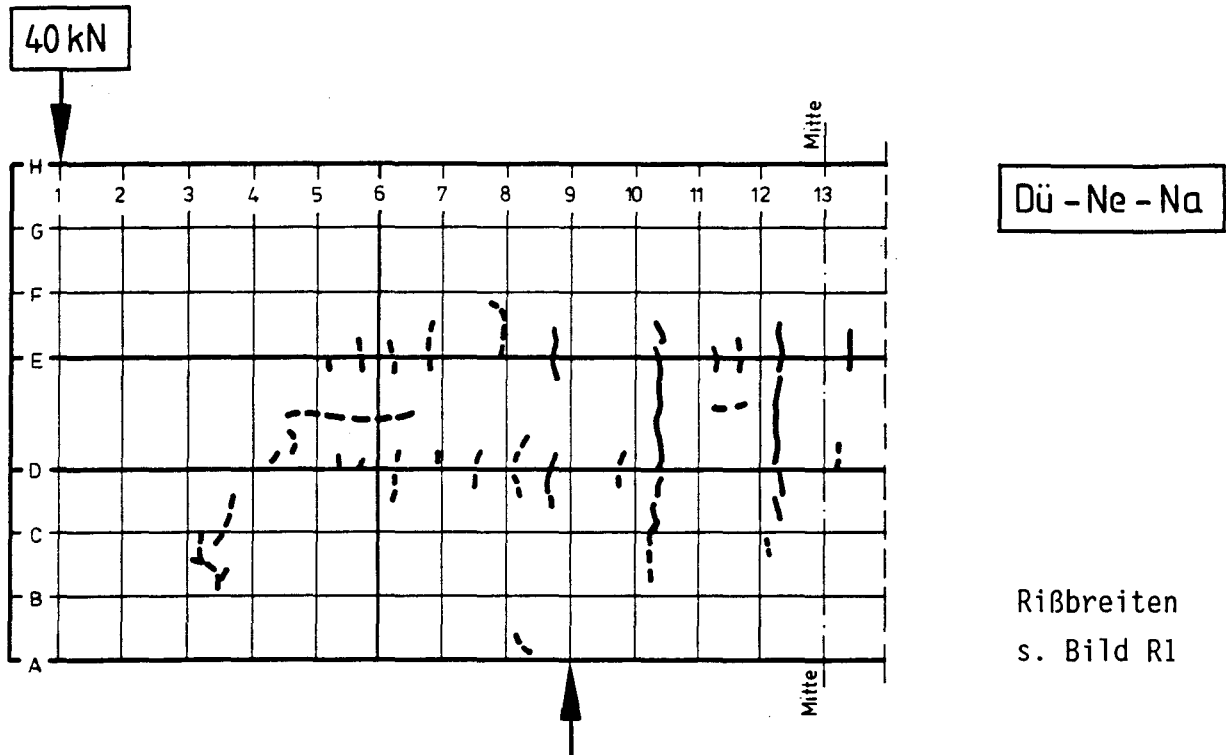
Rißbild unter Gebrauchslast, Ergänzung mit Normalbeton
